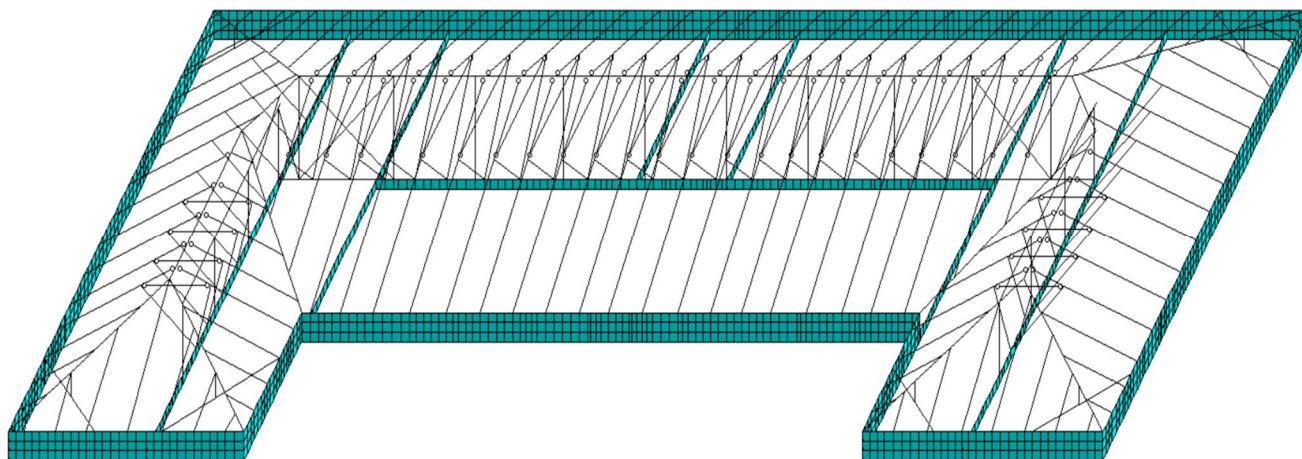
Розрахункова схема несучих конструкцій покриття будівлі.
